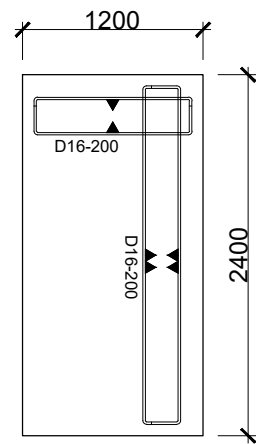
DETAIL PELAT LANTAI DENGAN B2 & Ba2
